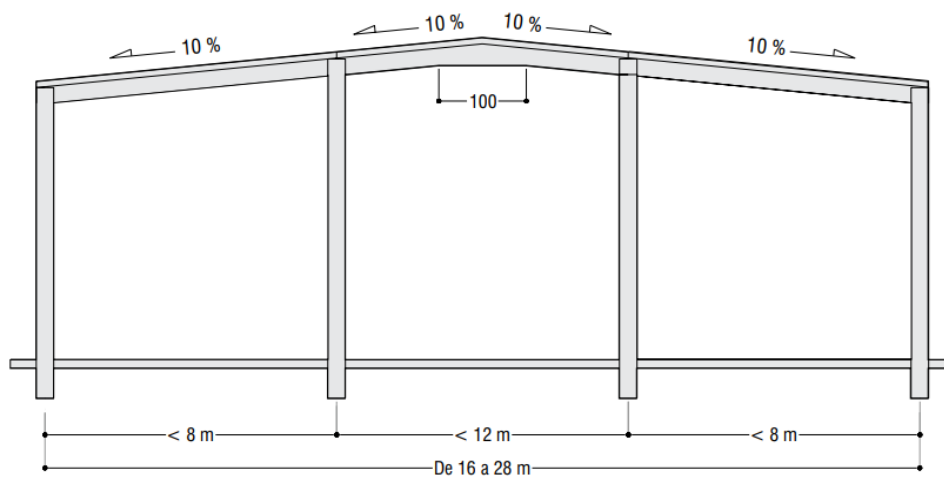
Restriccions pilars i jàssera de façana. Font: Prefabricats Planas
